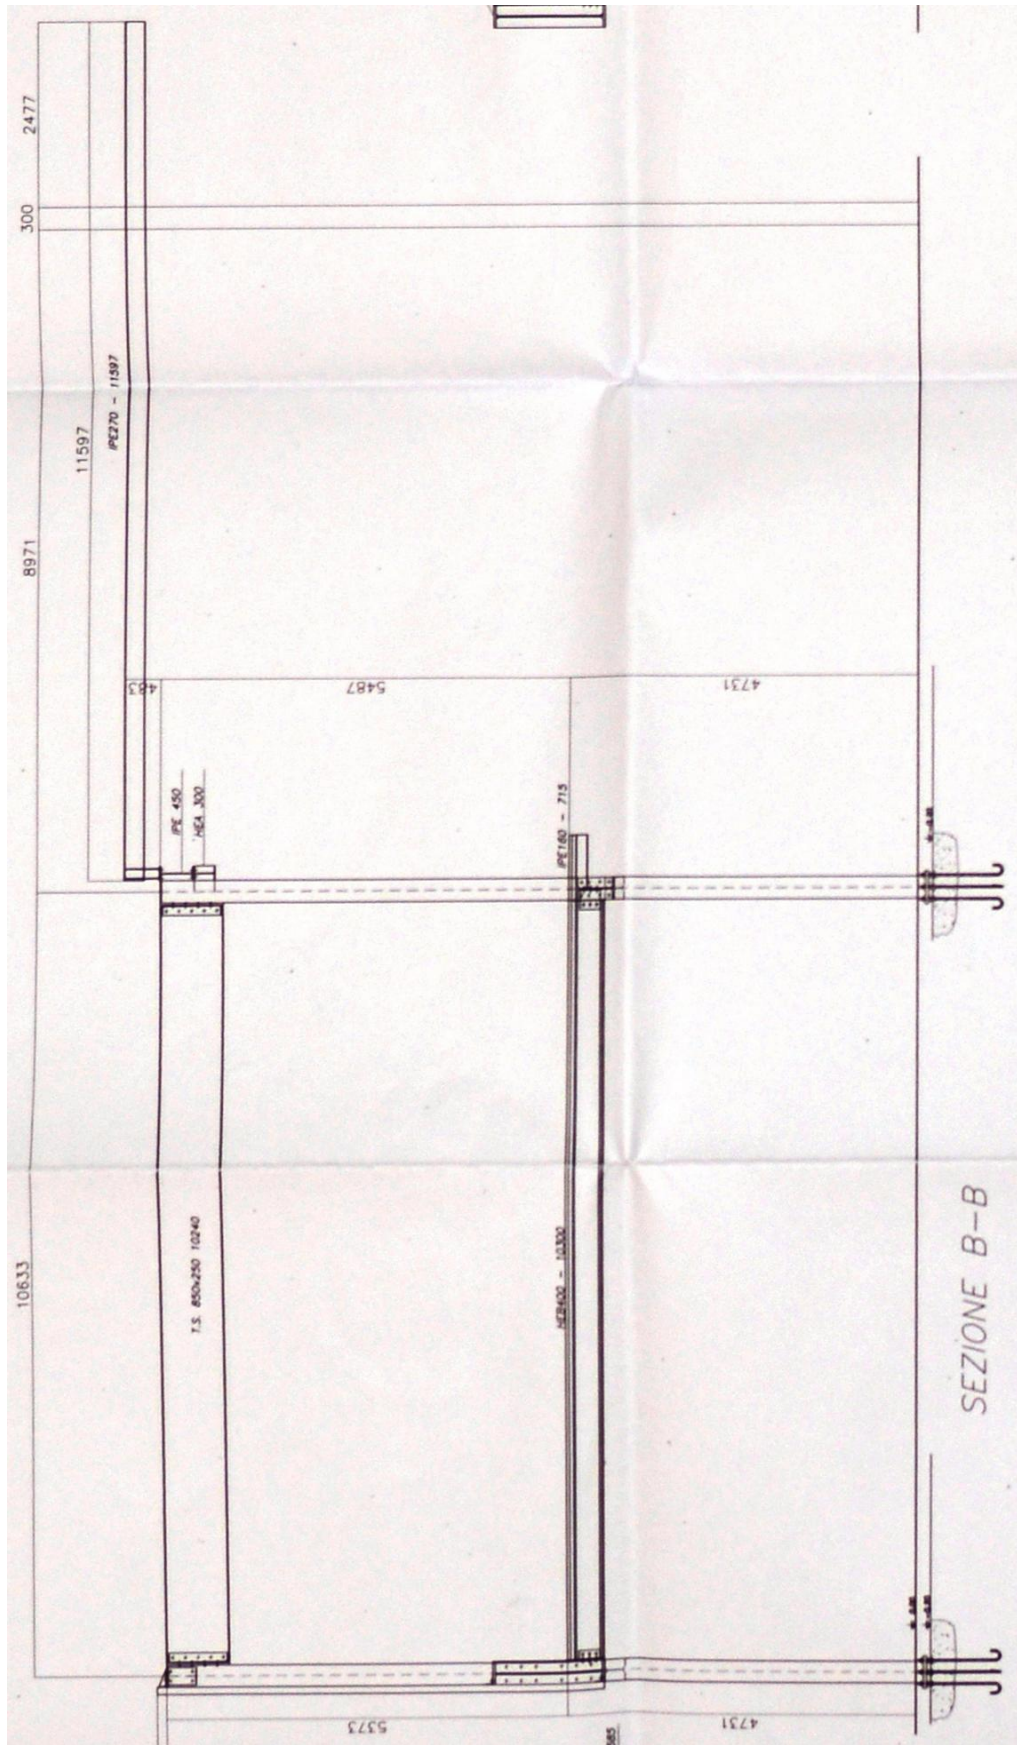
Particolare di A.2003.a.us.b.T05 - Sezioni - Sezione B-B
